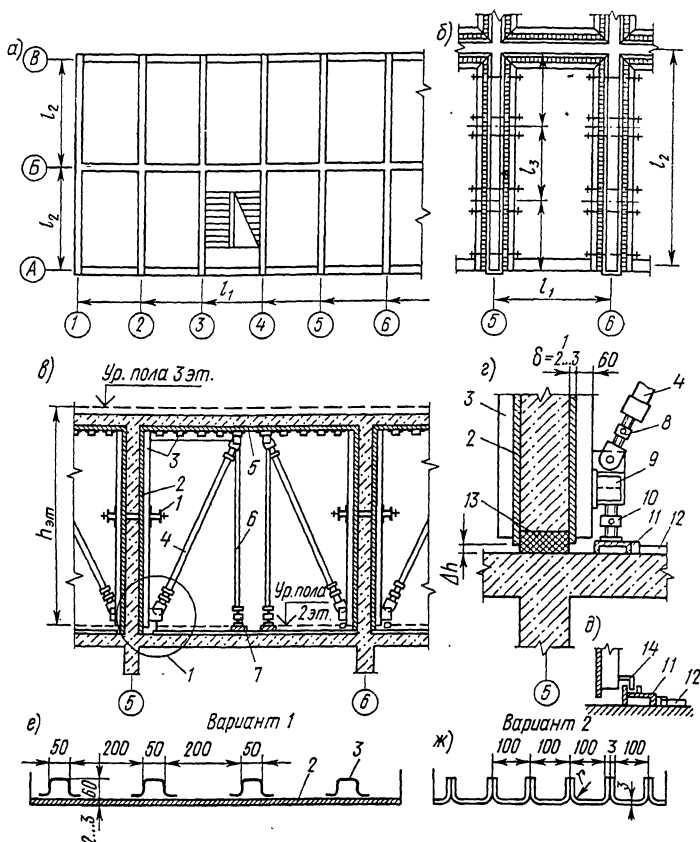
Технология монтажа стальной секционно-переставной опалубки для возведения жилого дома из монолитного бетона
